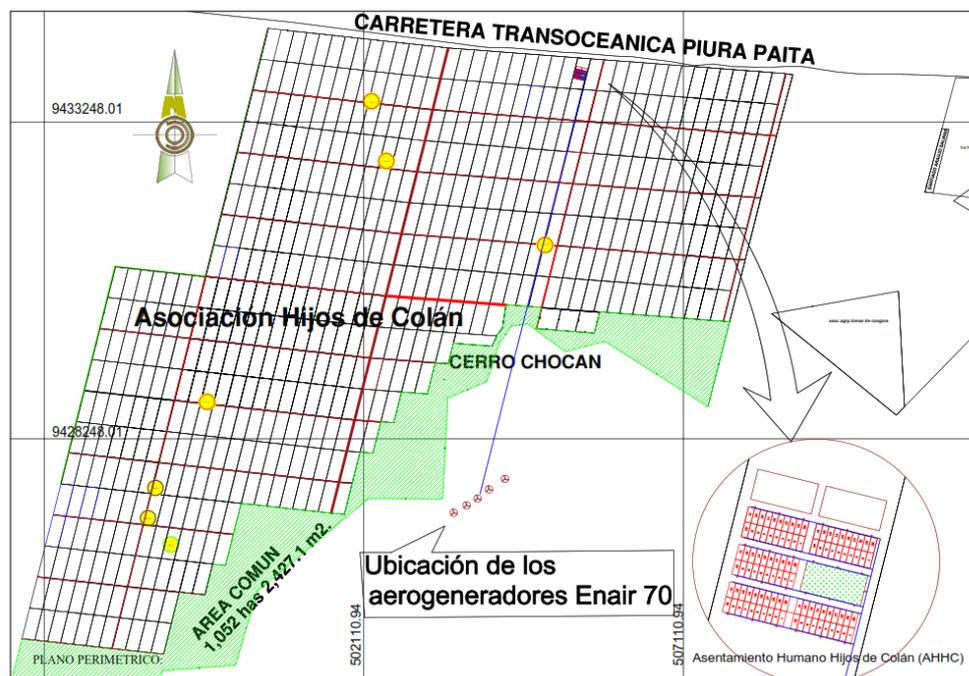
Cableado de media y baja tensión para distribución al AHHC
